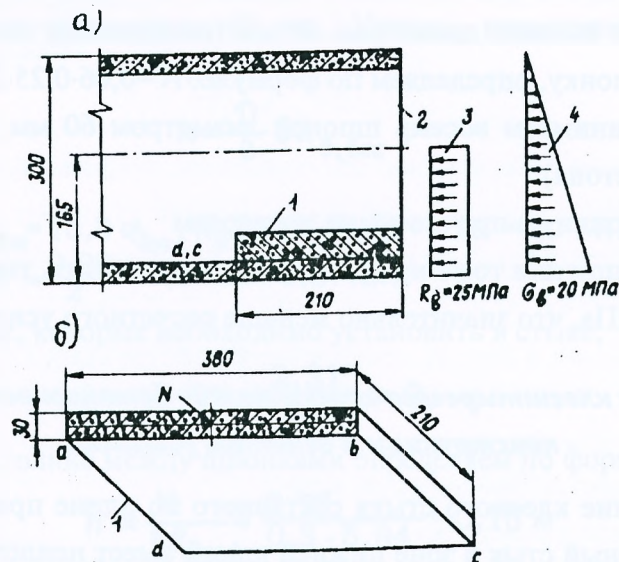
Схемы к определению усилий, действующих в клеештыревом стыке: а – усилия, действующие на отсеченную по дефектному стыку часть балки; б – усилия, действующие на отсеченную часть бетона усиления; 1 – бетон усиления; 2 – дефектный стык; 3, 4 – этюры нормальных напряжений в предельном со-
